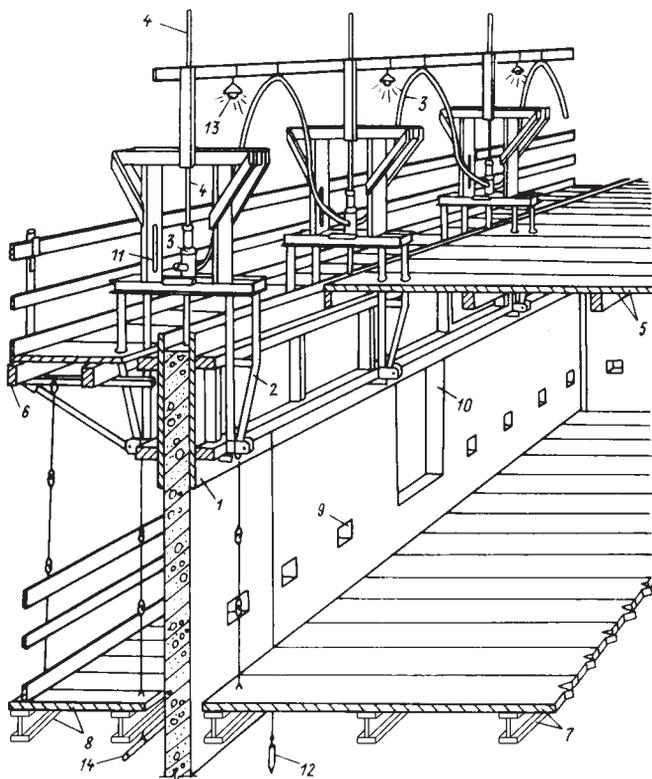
Общий вид скользящей опалубки (1 — щит опалубки; 2 — домкратная рама; 3 — гидродомкрат; 4 — домкратные стержни; 5 — верхняя внутренняя рабочая площадка; 6 — верхняя наружная рабочая площадка; 7 — нижняя внутренняя рабочая площадка; 8 — нижняя наружная рабочая площадка; 9 — отверстия для опирания перекрытия; 10 — дверной (оконный) проем; 11 — оборудование для контроля горизонтальности скользящей опалубки; 12 — оборудование для контроля вертикальности сооружения; 13 — электрическое оборудование; 14 — система водоснабжения)
